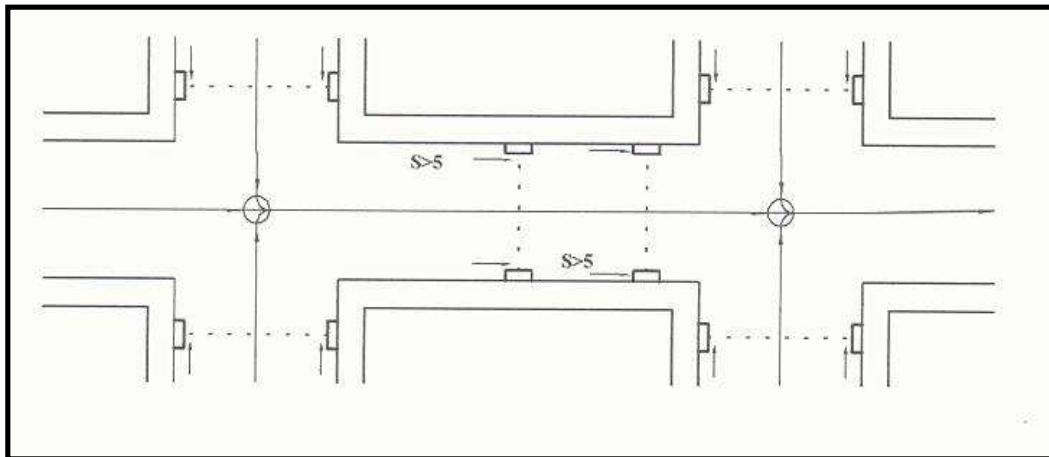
Ubicación de coladeras longitudinales de banqueta.
